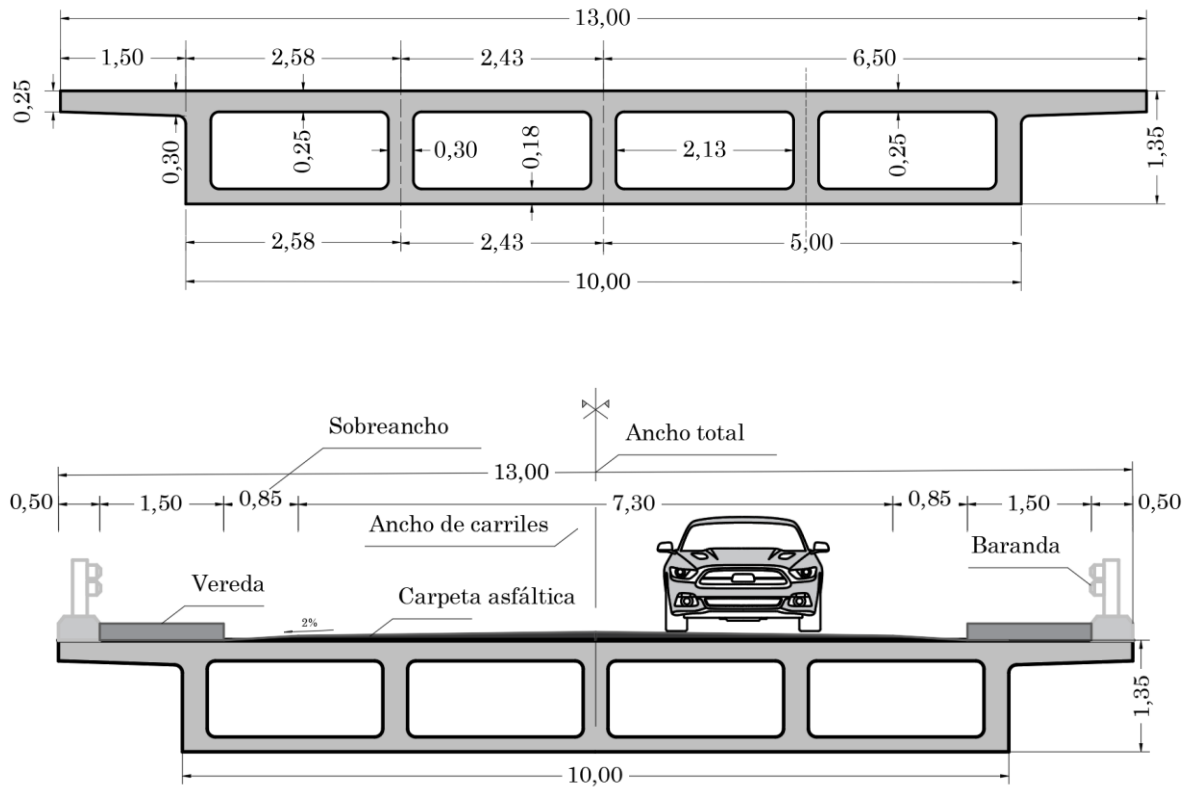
Esquemas de la sección predimensionada (Fuente: Elaboración propia).
